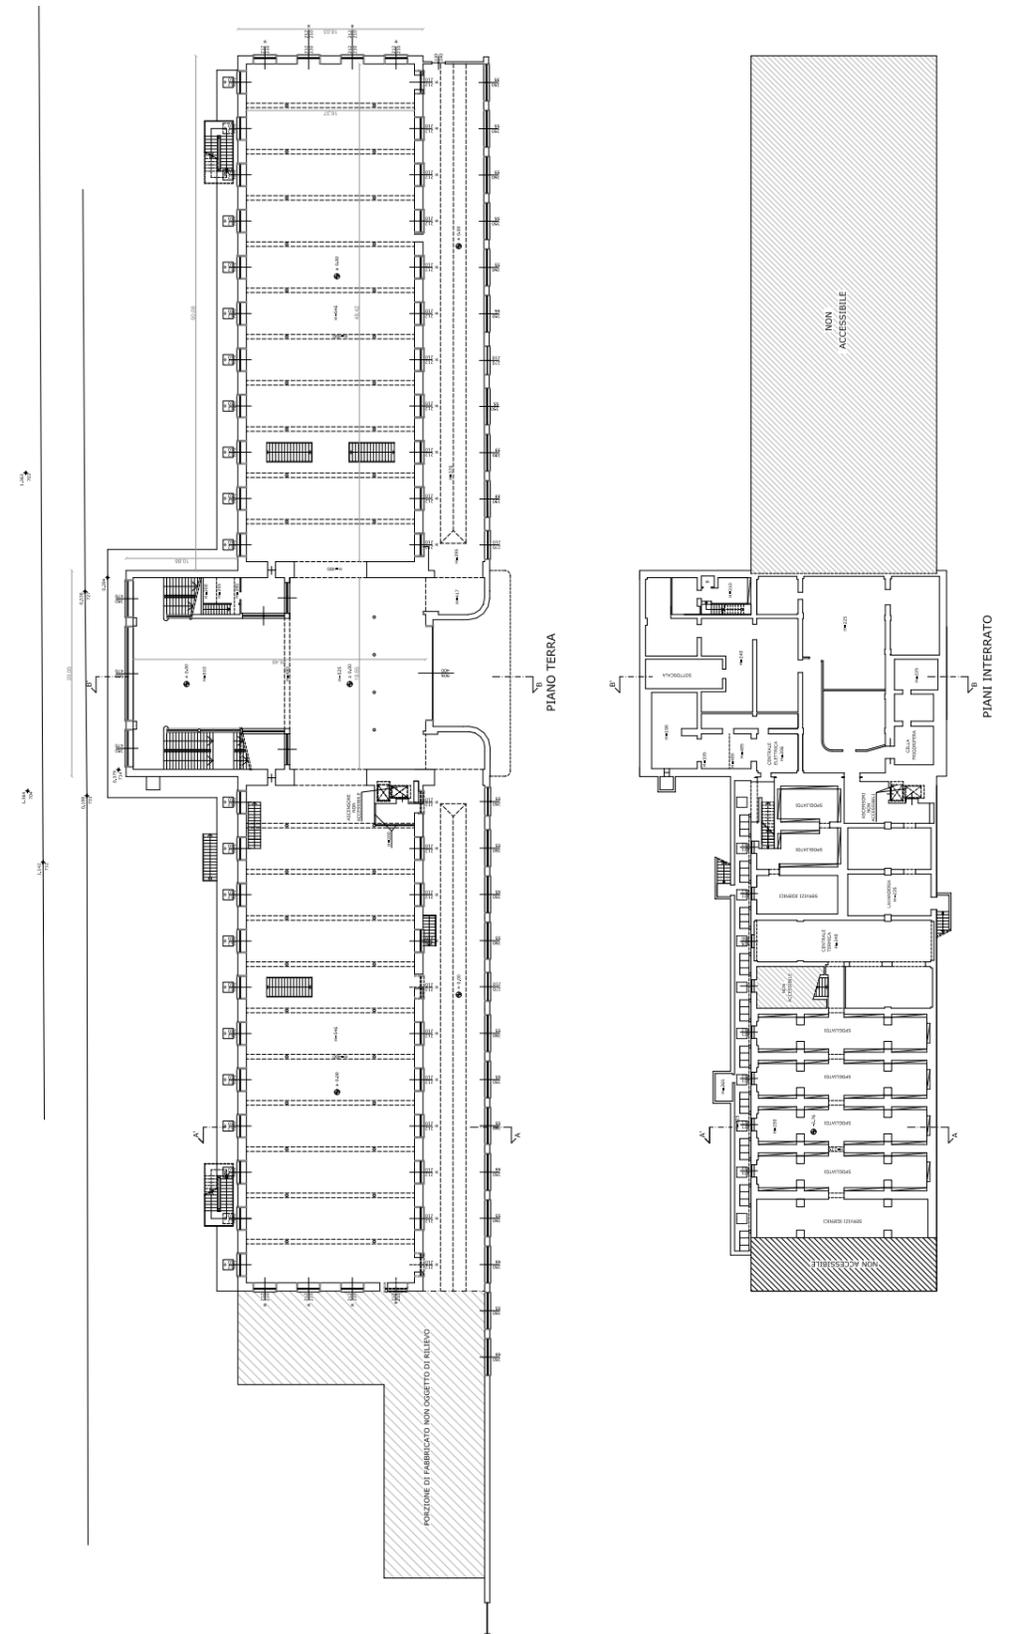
| “Stato di fatto - Pianta piano terra e primo interrato“, 2011 | fonte: Arch. Marina Basso
